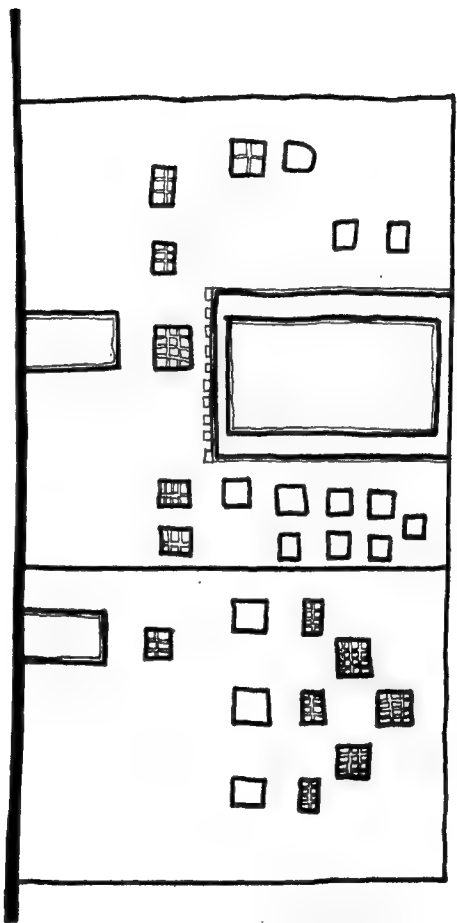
منزل القاضي عمر الدور الثاني - مسقط أفقي
